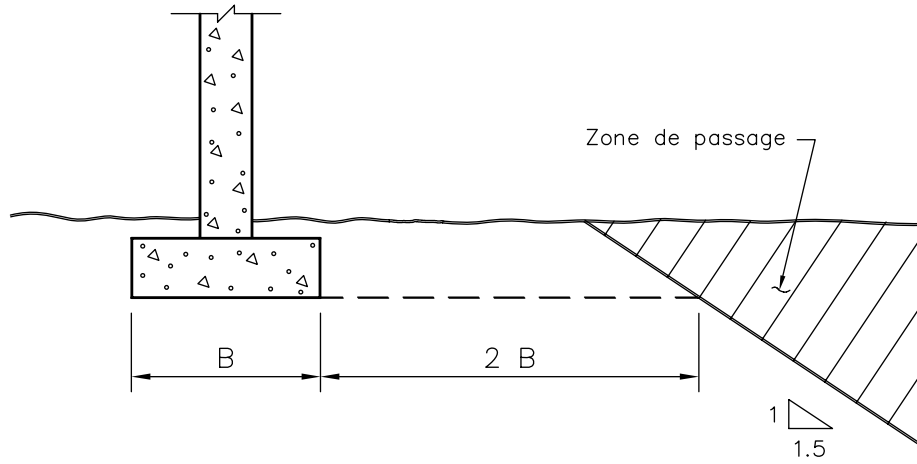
Zone de passage d'un conduit ou d'un groupe de conduits près d'une pile
